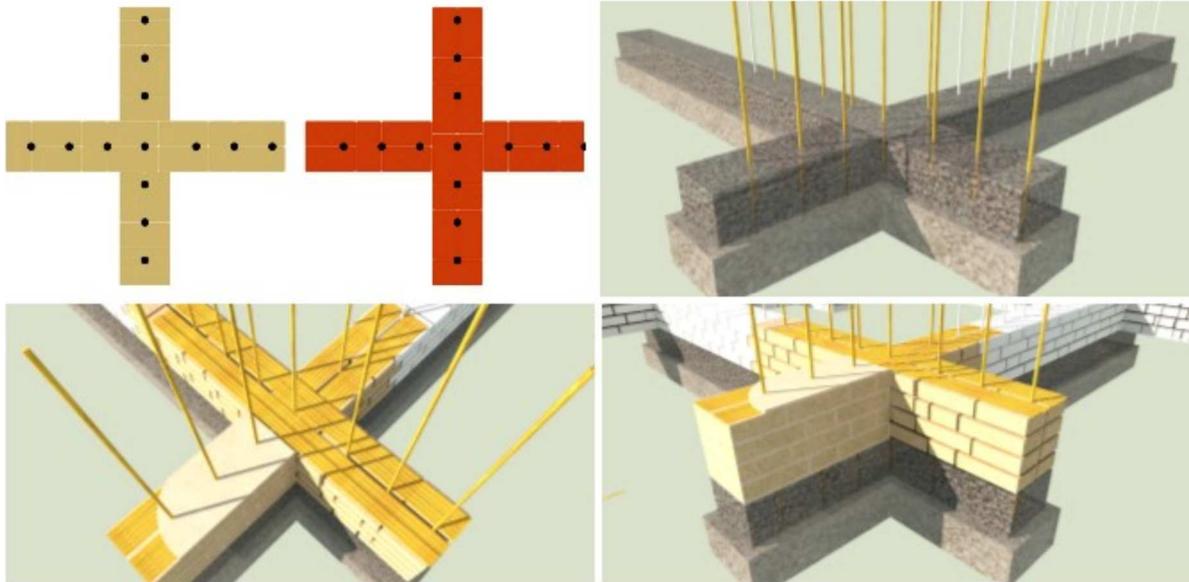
Detalles del sistema constructivo para muros en adobe y caña: cemento, sobrecimiento, trabas de hiladas pares e impares, y entramado vertical y horizontal de cañas.
